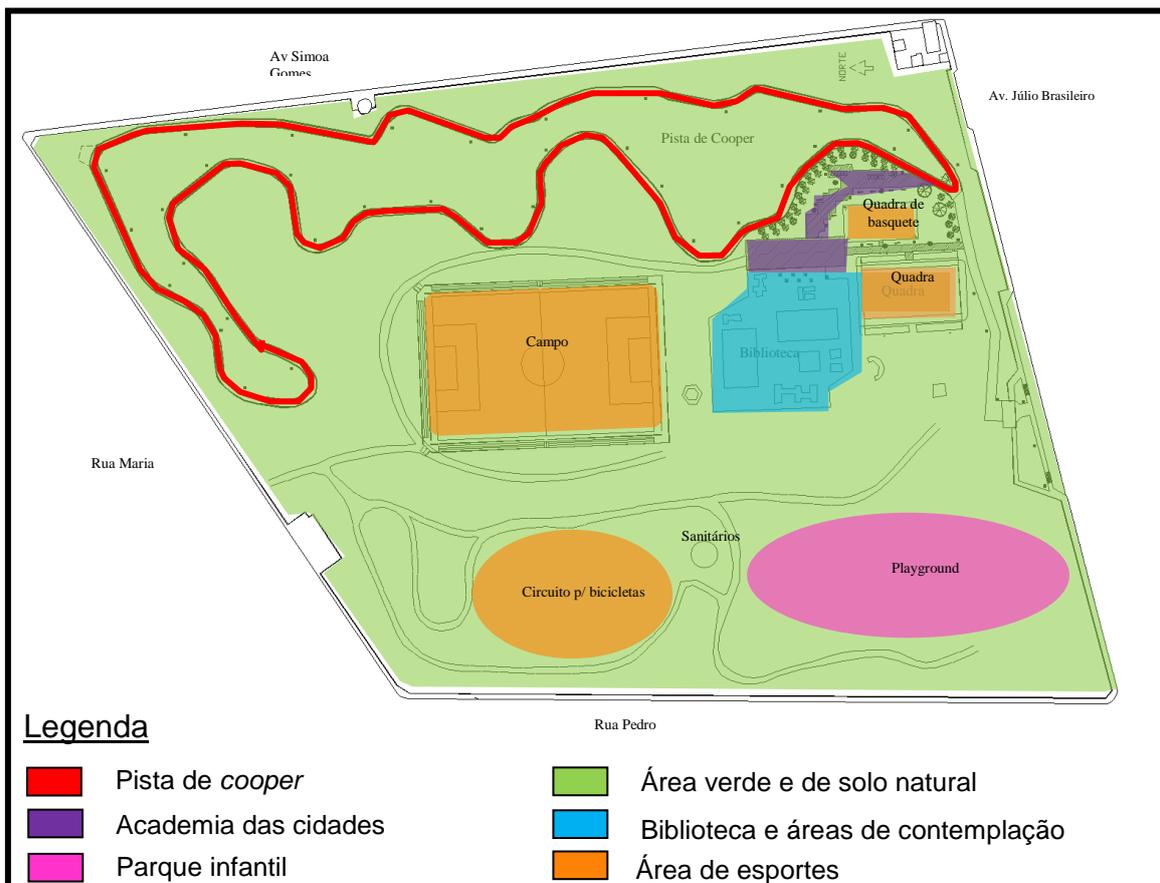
Zoneamento da Planta Baixa da Academia da Cidade de Garanhuns
